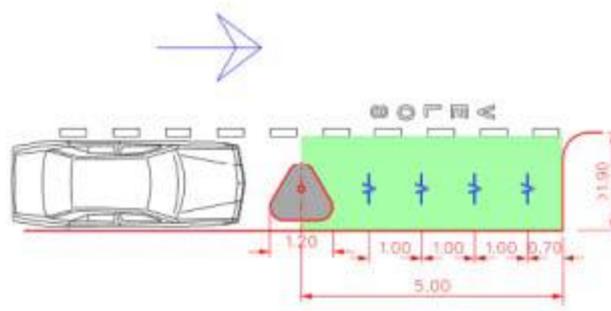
Schéma type d'implantation du stationnement en arceaux à la place d'une case de stationnement
